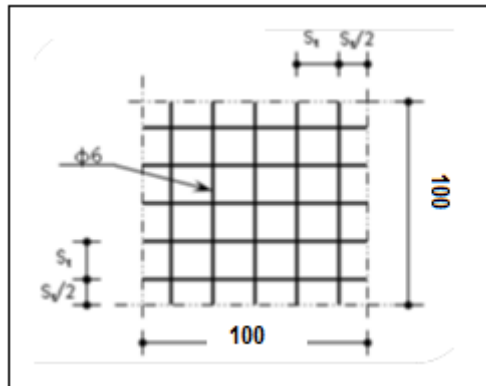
Dispositions constructives des armatures de la dalle de compression.
